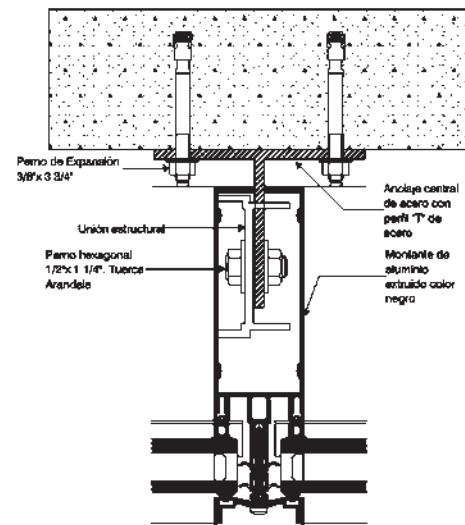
Sección de montante y anclaje a losa de sistema de muro cortina. Elaboración propia.
